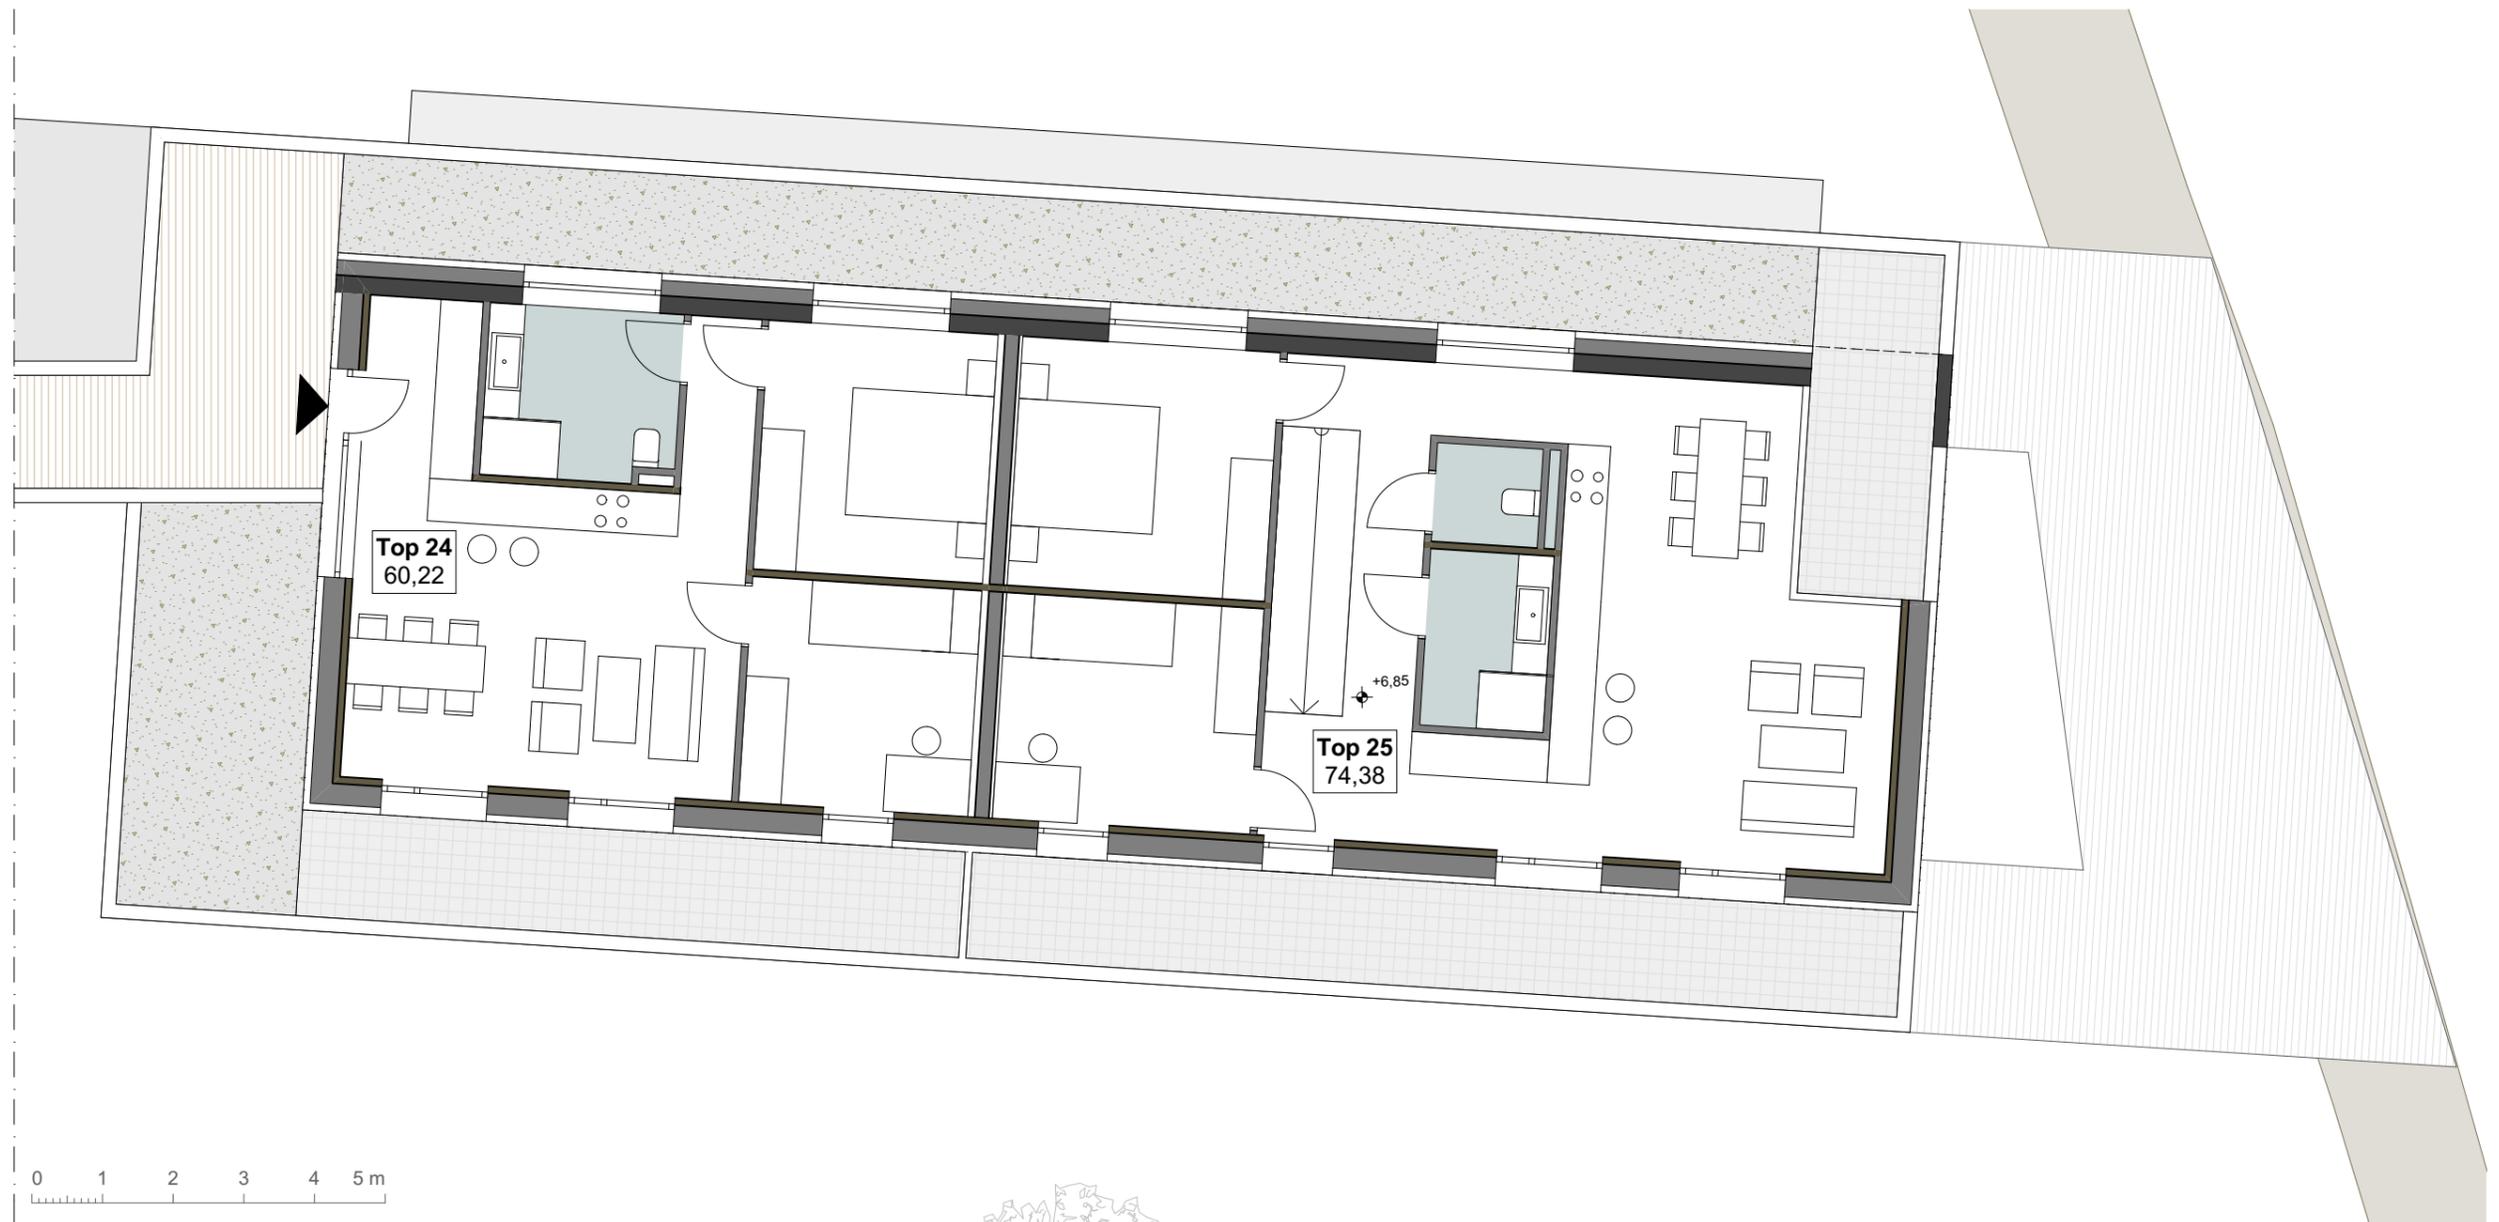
Wohnungstypen Bauteil 2: zweites Dachgeschoss
